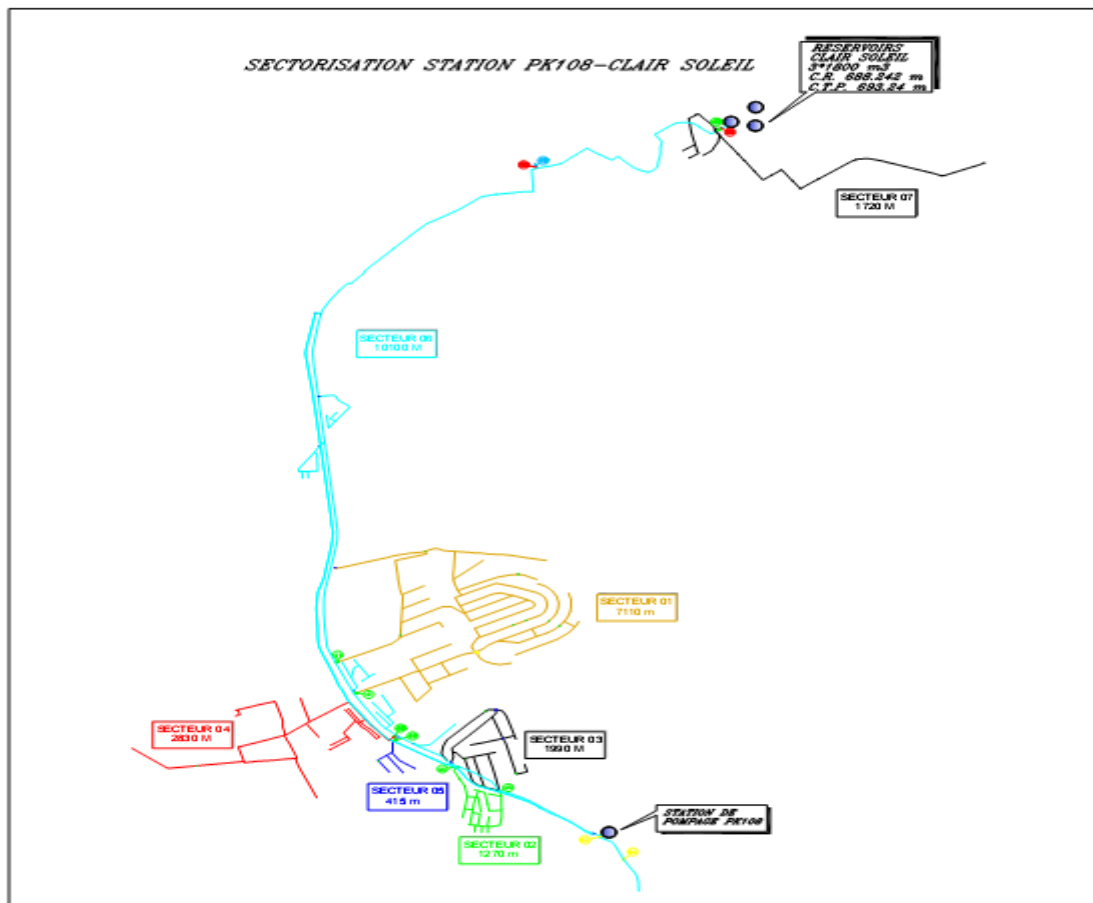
Plan de sectorisation du secteur St PK108-Clair soleil.
